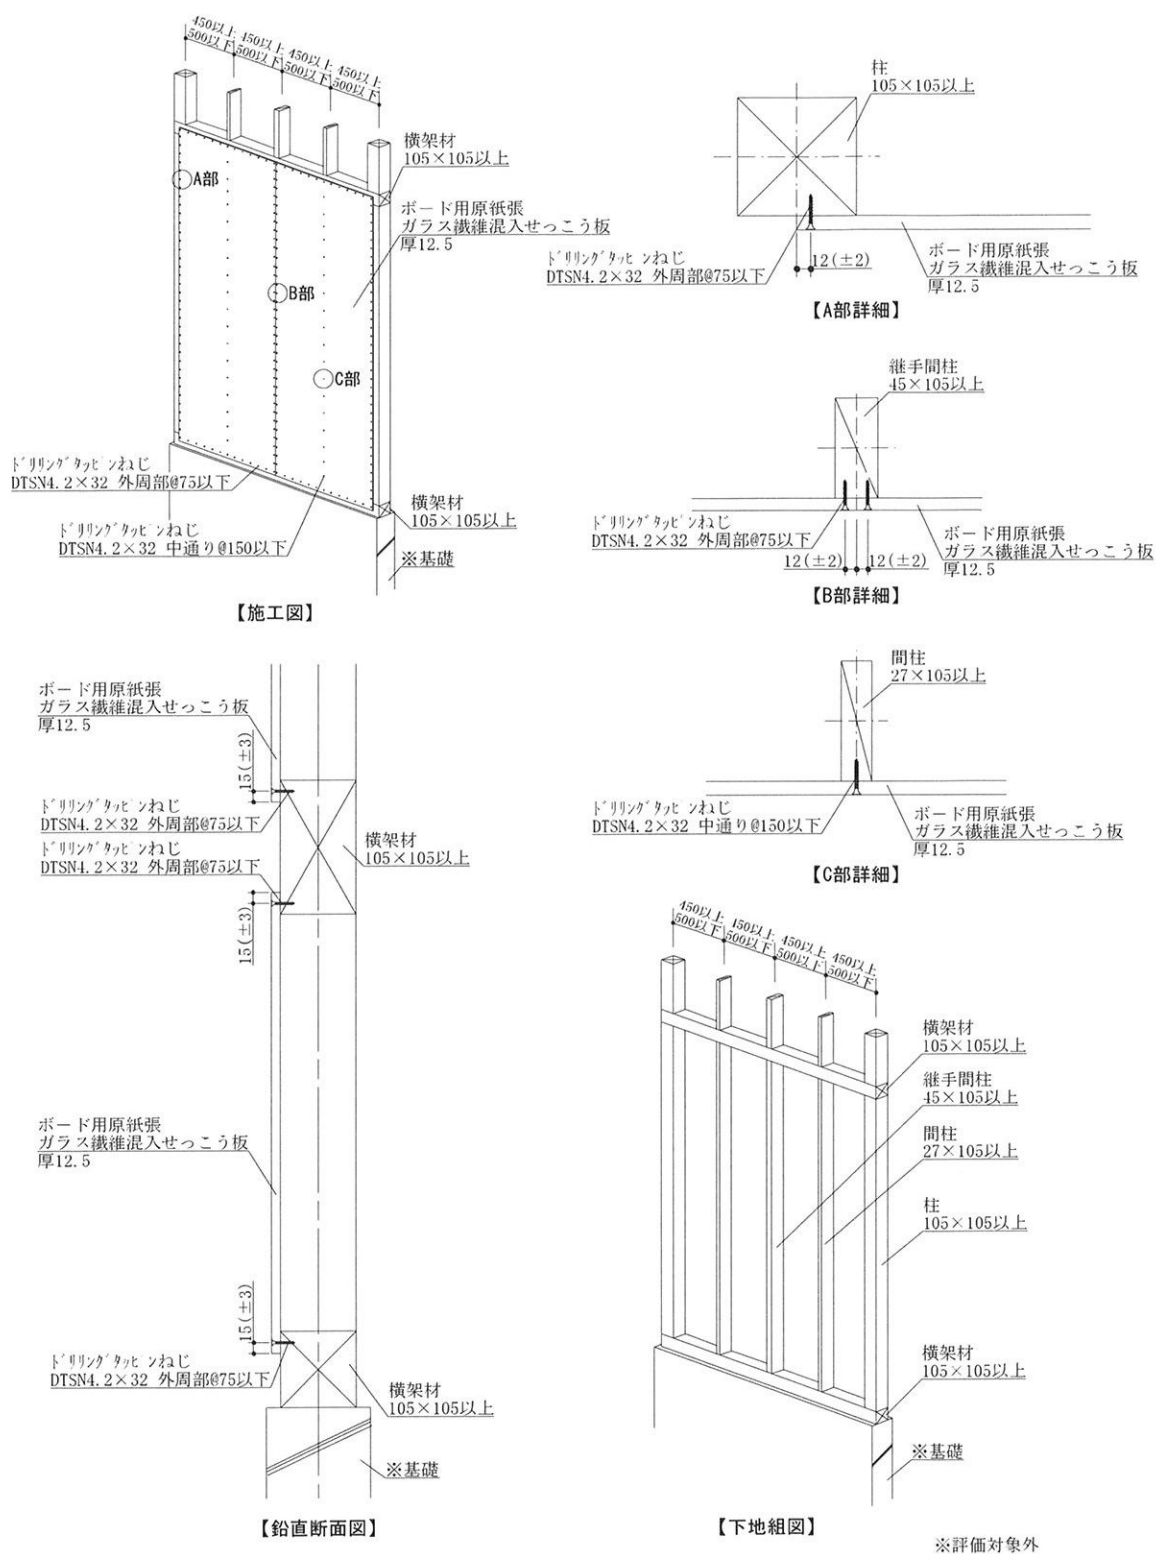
施工詳細図：1枚張りの場合（寸法単位：mm）
